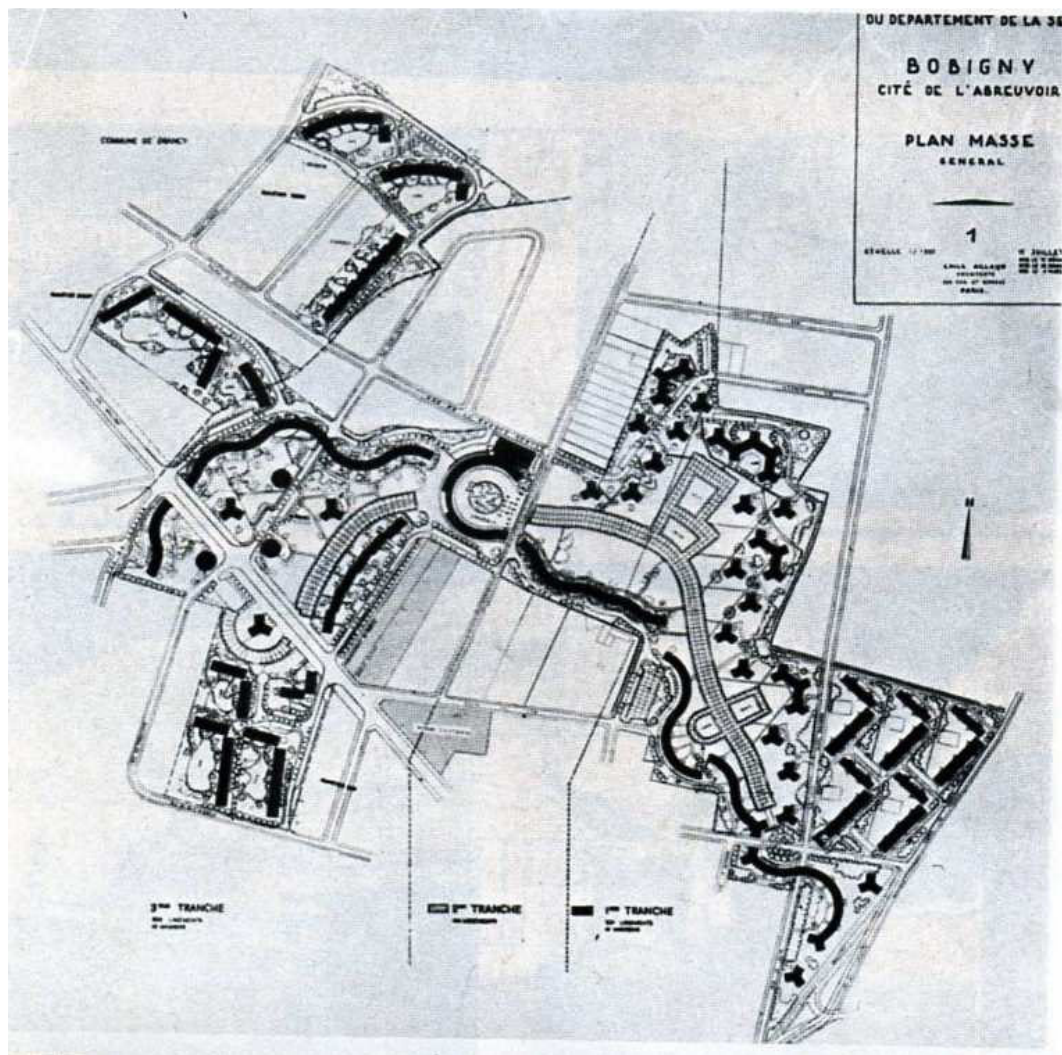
Planimetria generale dell'intervento redatta dagli architetti E. Allud e J. Vedrés;
